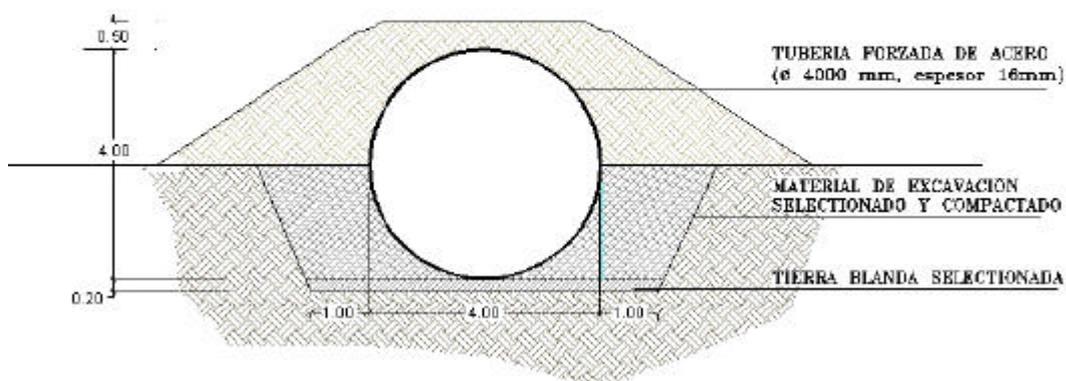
Vista en corte de la Cañería Semienterrada
